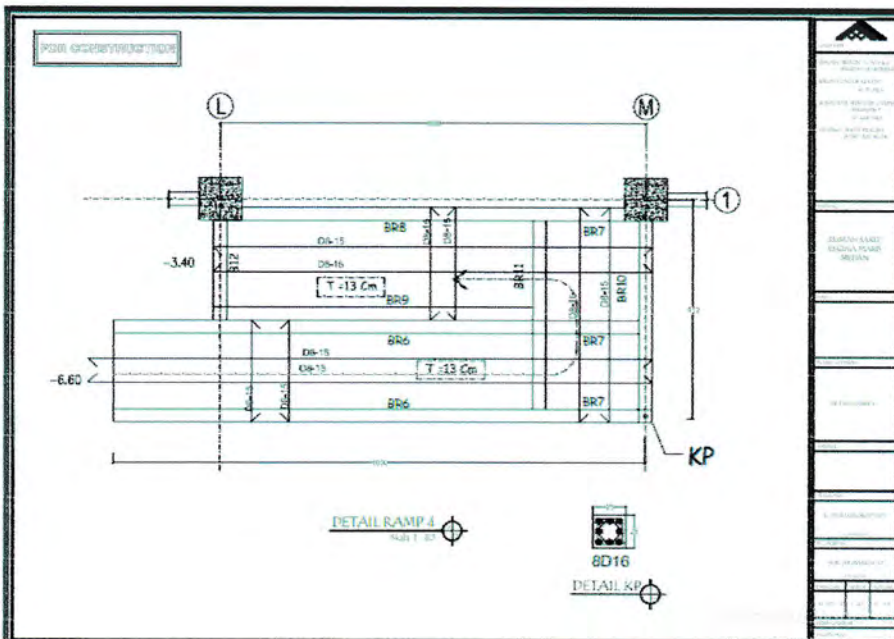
Bentuk Kolom Dilantai Basement 2 & Basement 1
